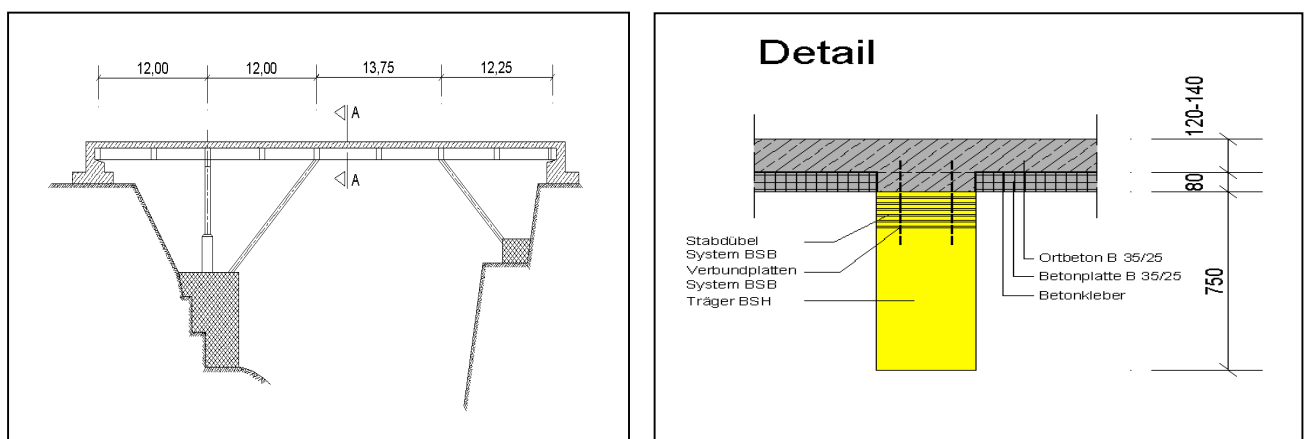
Querschnitt und Detail der Brücke nach [56]
